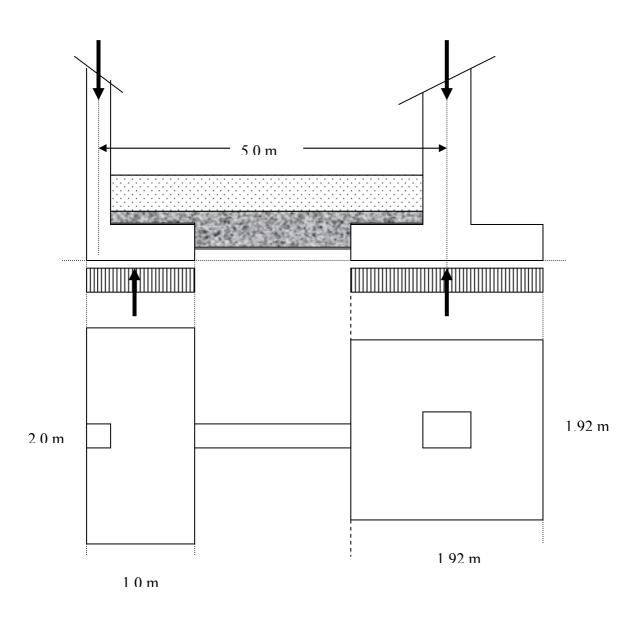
Dimensiones preliminares de zapata con viga de enlace
